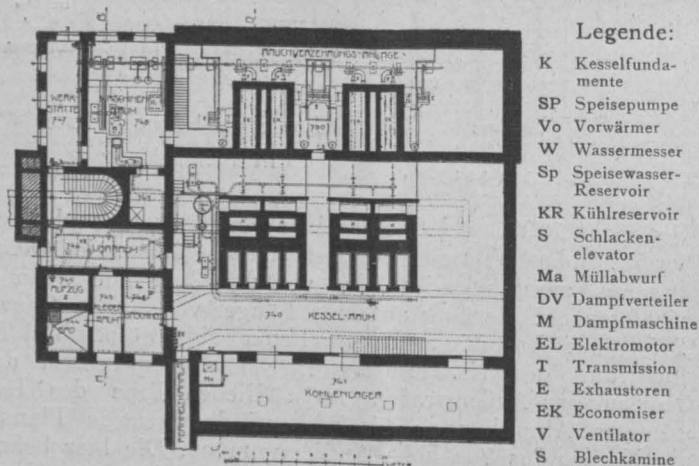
Kesselhaus, Untergeschoßgrundriß
